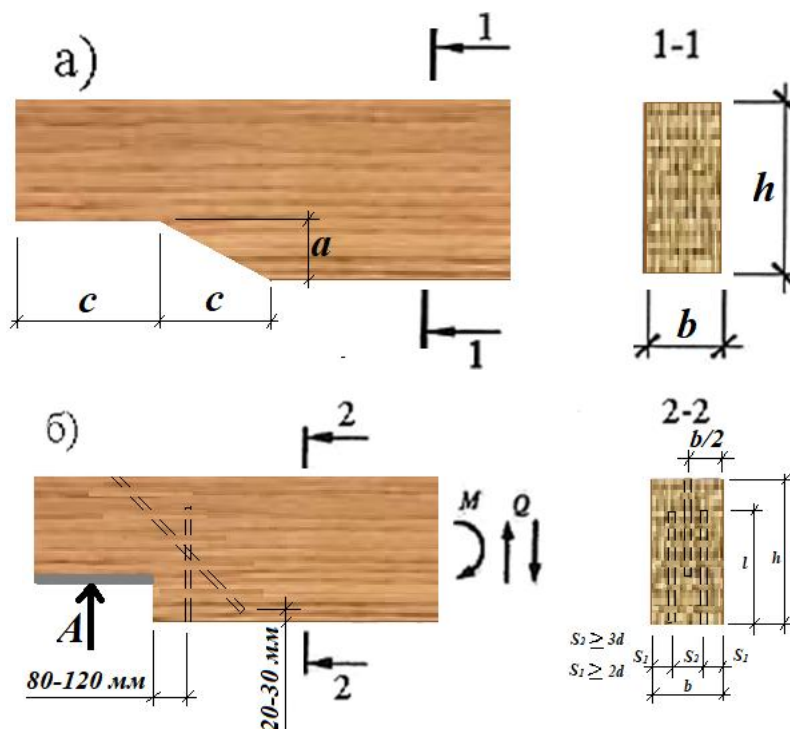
Подрезка балки на опоре: а) - скошенная подрезка конца балки, б) - усиление подрезки на конце дощатоклееной балки
